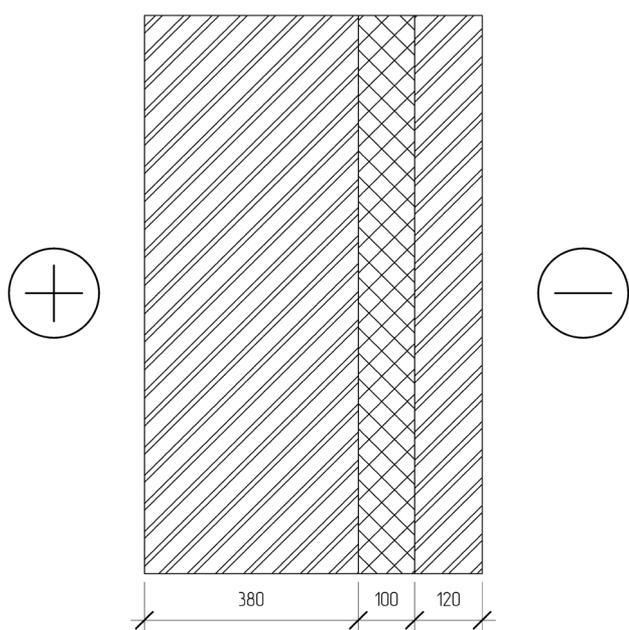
Конструкция стены из кирпича с утеплителем и облицовочным слоем
